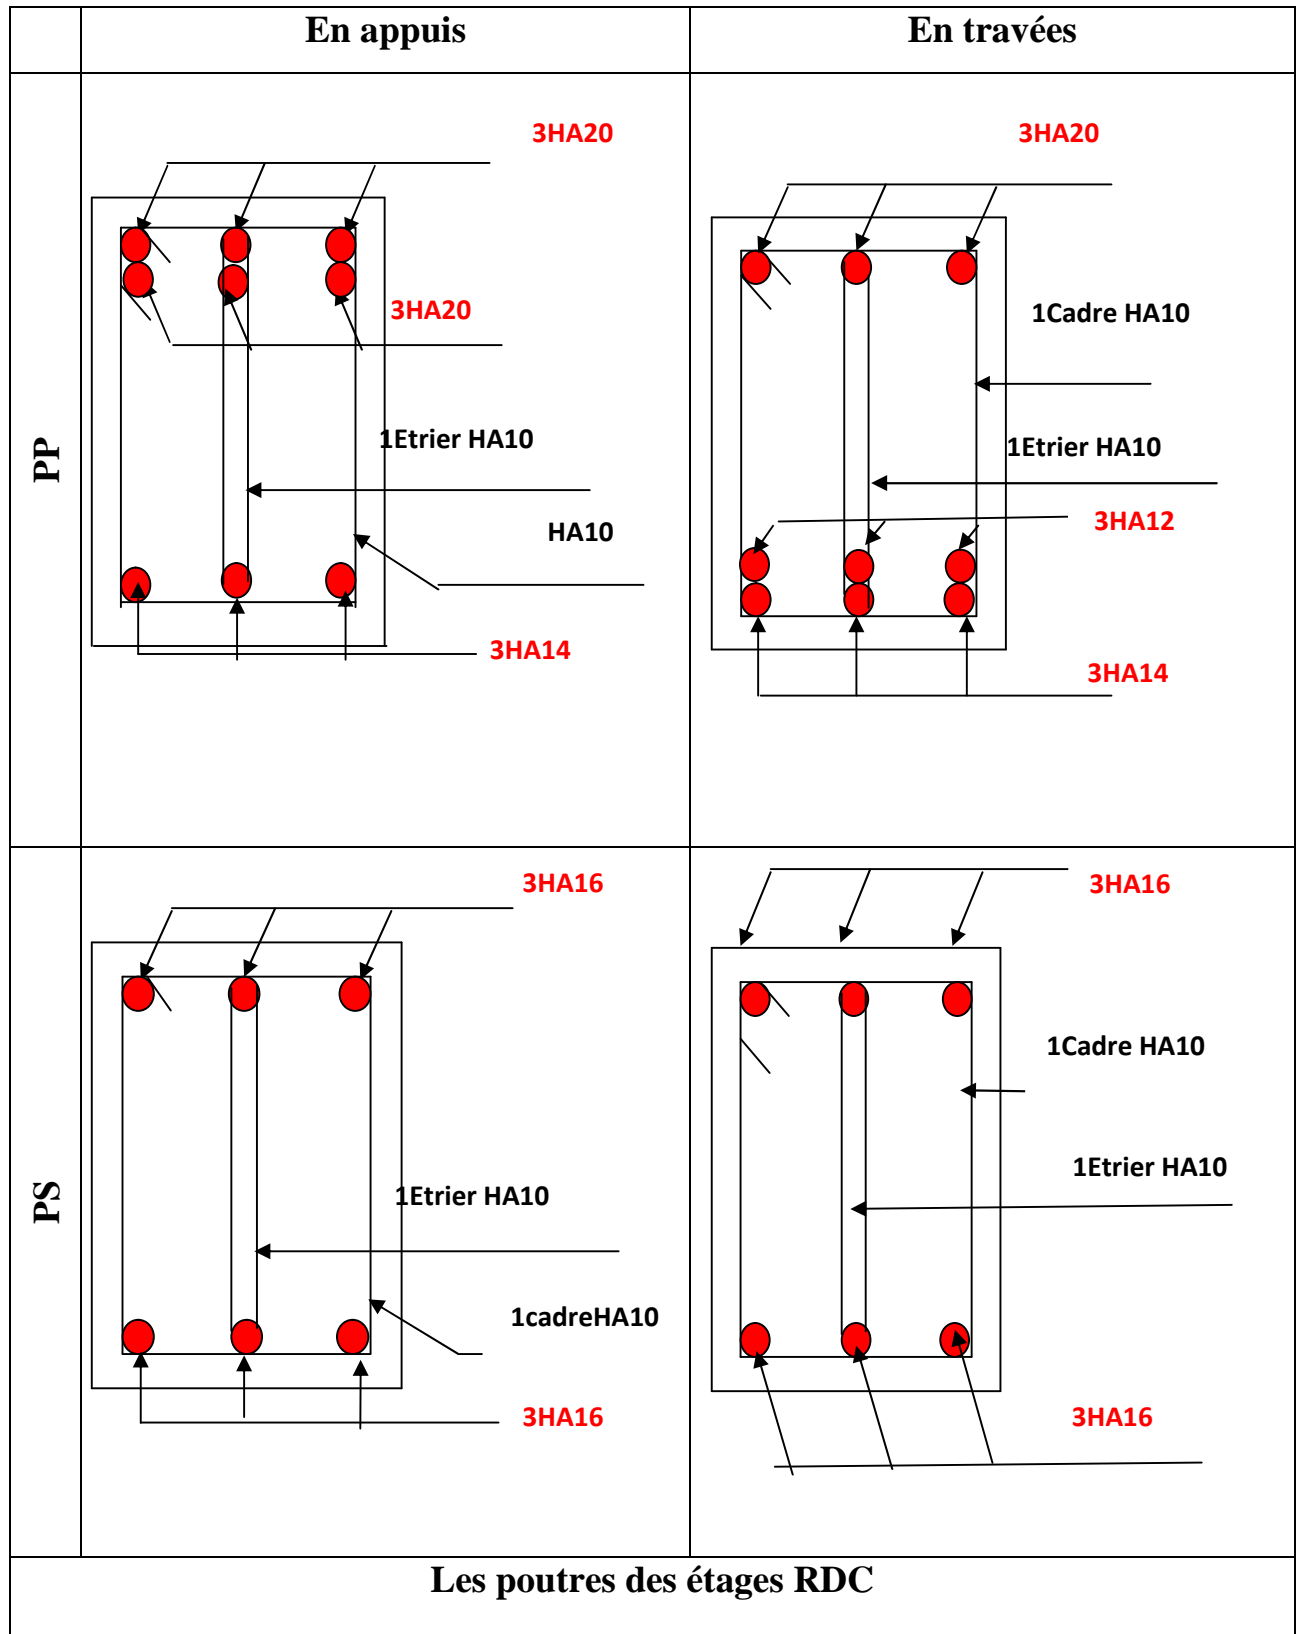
Schéma constructif de la poutre du RDC.
